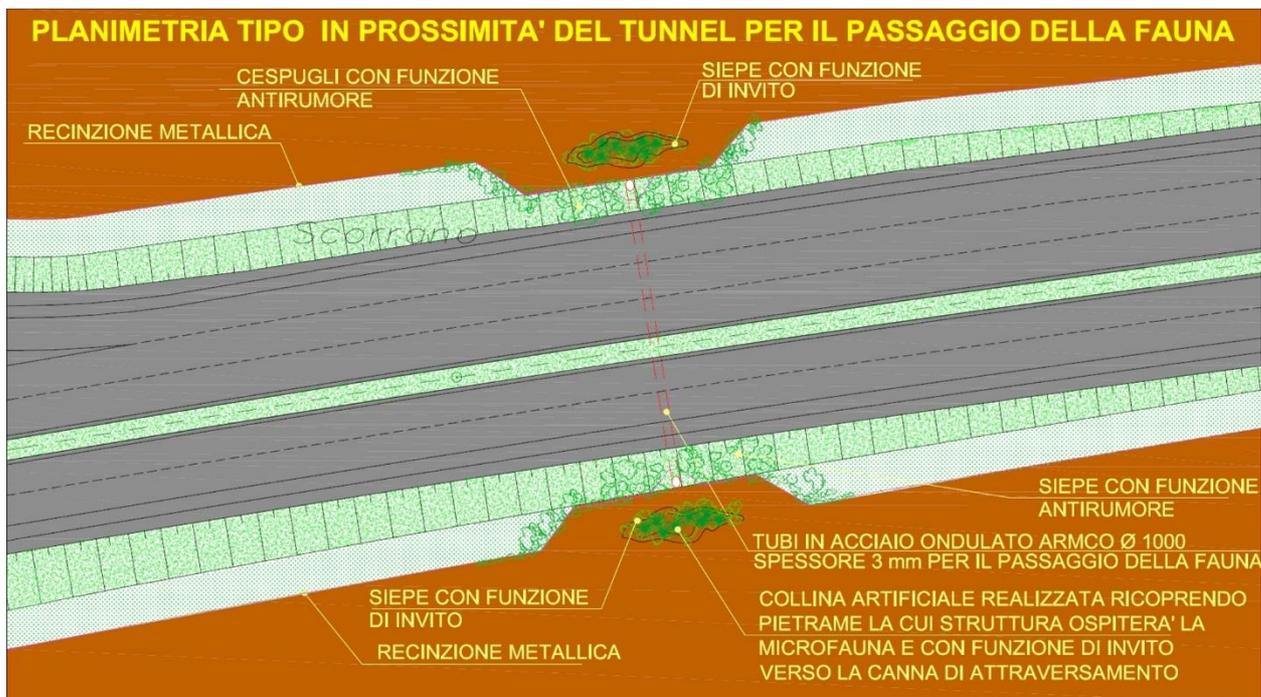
Planimetria tipo in prossimità del tunnel per il passaggio della fauna
